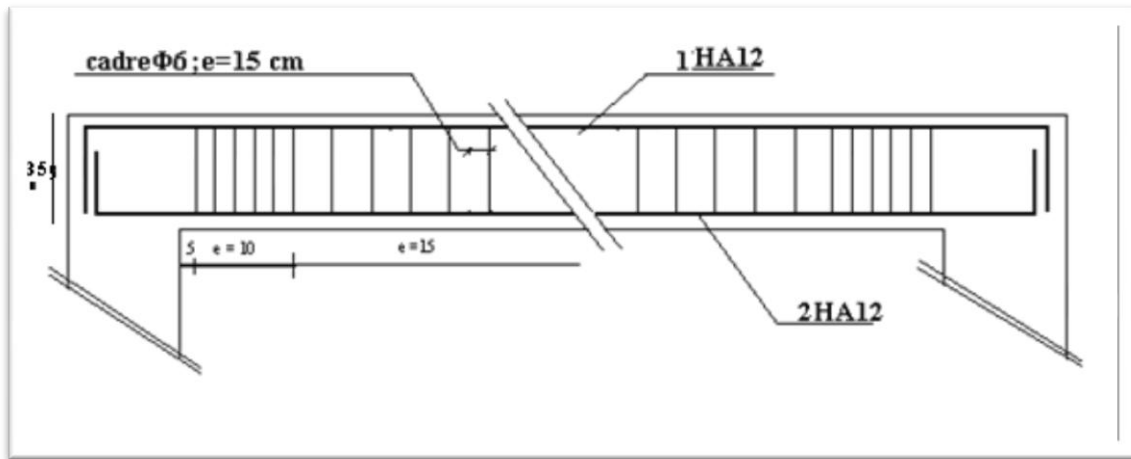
Disposition d'armature dans la poutre secondaire 30x30
